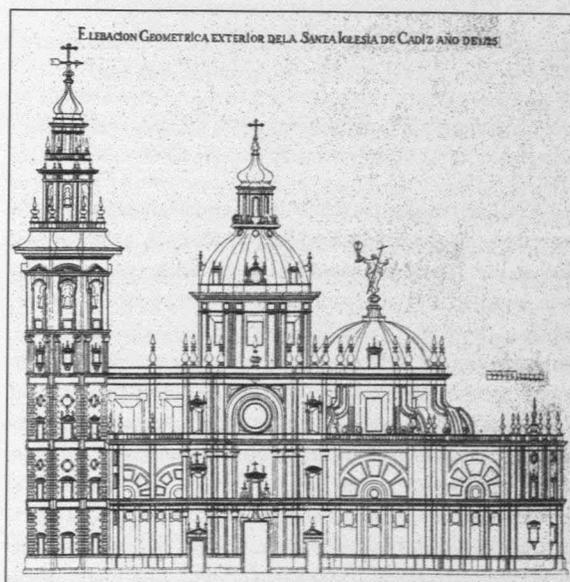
Catedral de Cádiz. Alzado longitudinal de 1725 sobre el calco de Pablo Gutiérrez Moreno (1928).
